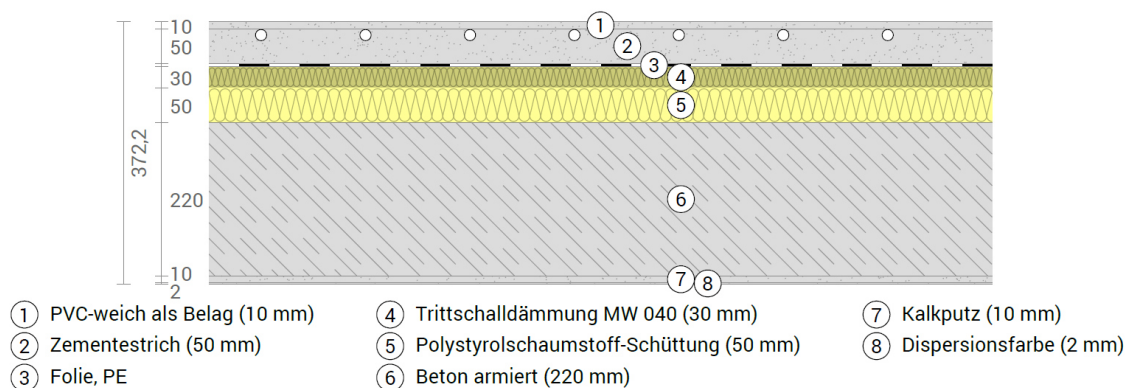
Bauteilaufbau der Geschossdecke im Wohnbereich (KNB-Variante)
